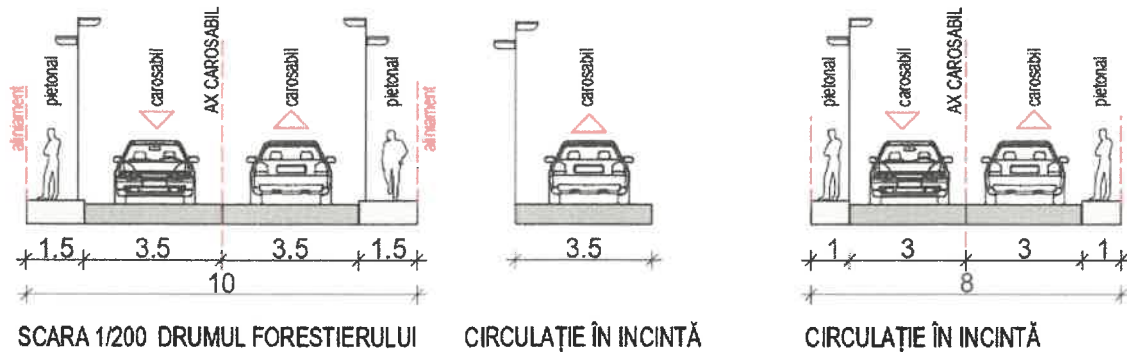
Profile stradale propuse (Extras din planșa Concept propus – Reglementări urbanistice)
